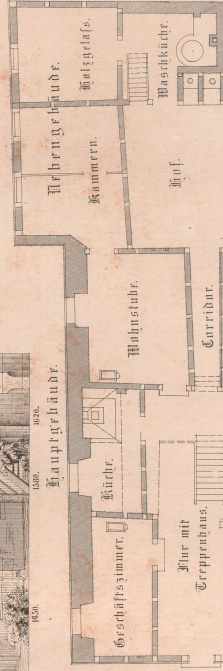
Grundriss eines mittelaltl. Fachwerkhanses in Braunschweig.
